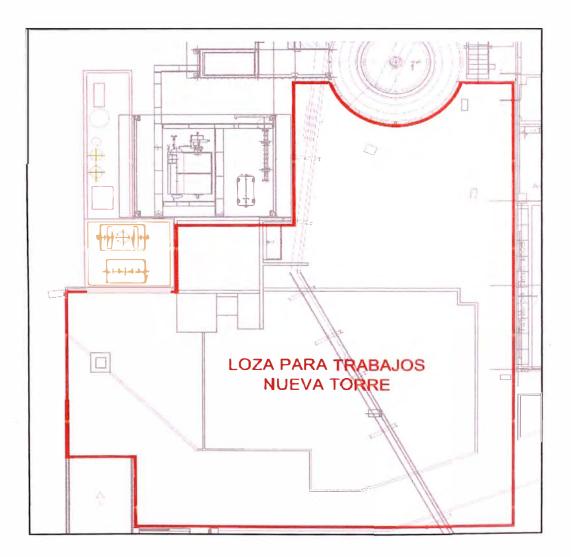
Vista de Planta de Tendido de tuberías actual
